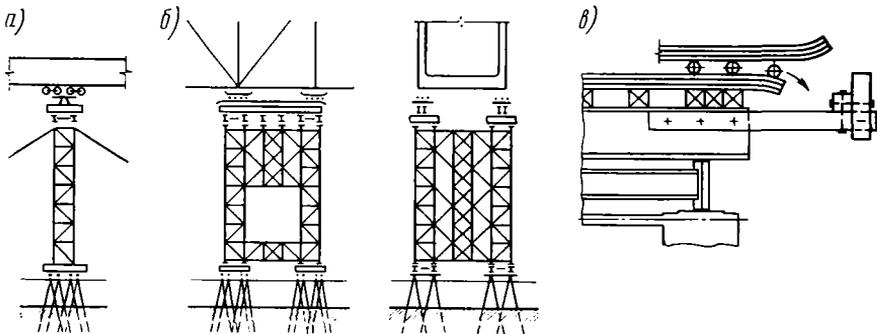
Вспомогательные опоры для продольной передвижки
